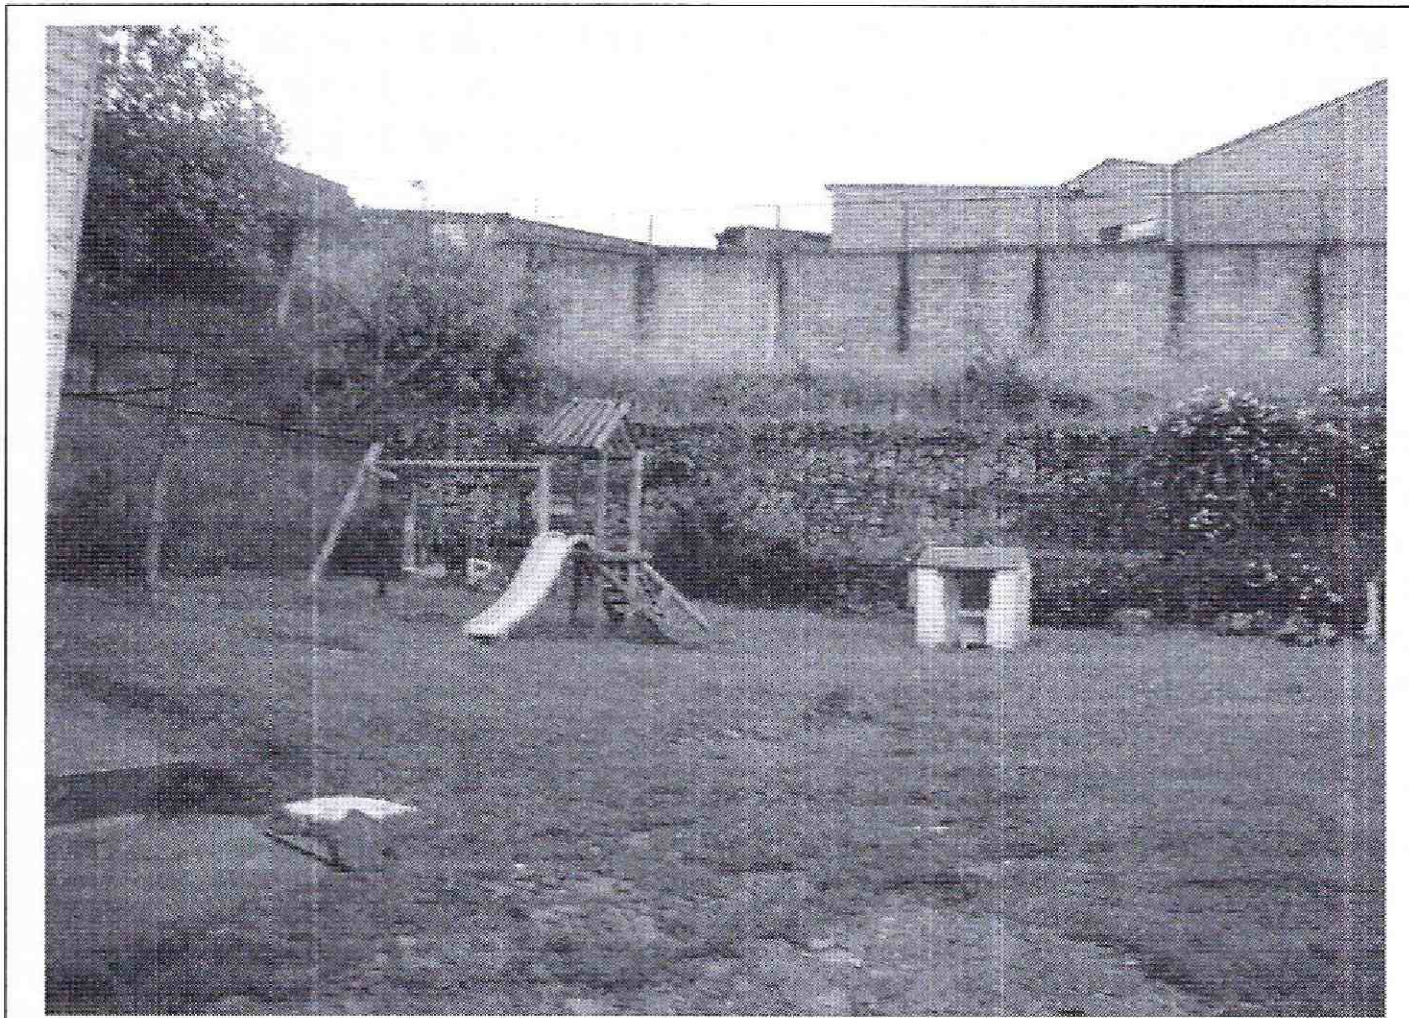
Muro de gaviones identificado sobre el costado norte del predio en donde se desarrollará el proyecto de la Carrera 1 # 1D-16, Localidad de Santa Fe.
